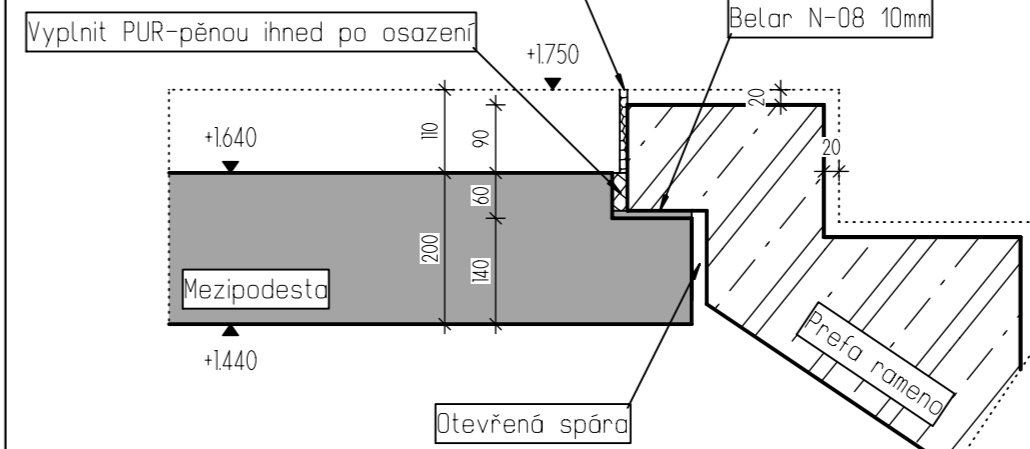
DETAILY PREFA BETON. SCHODIŠTĚ M1/25
